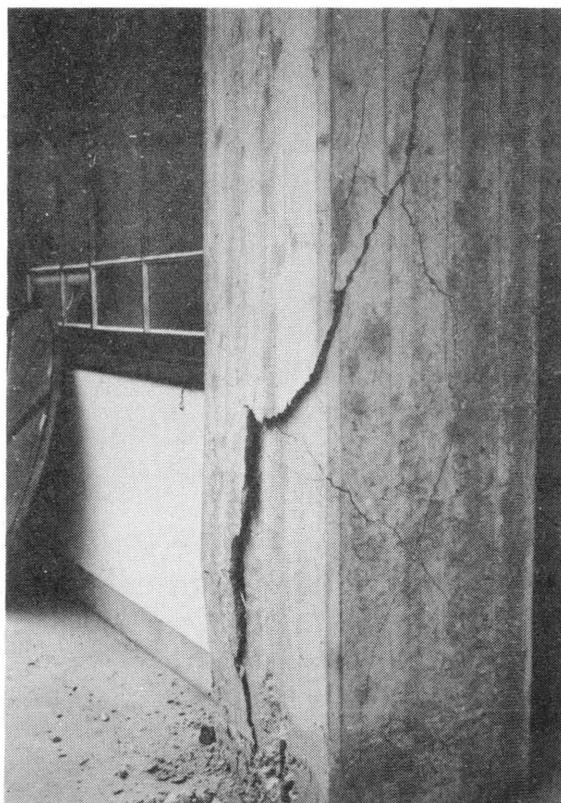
倉吉市庁舎コンクリート柱のひび割れ、はく離。
